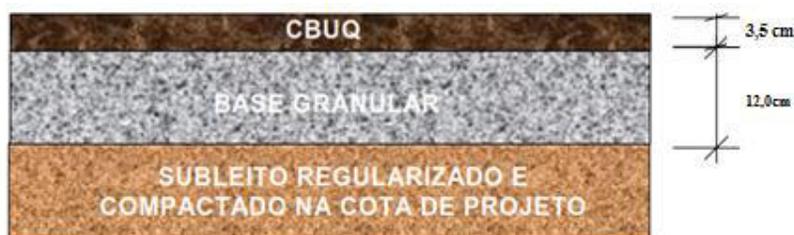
Estrutura do Pavimento flexível da Ciclovia
